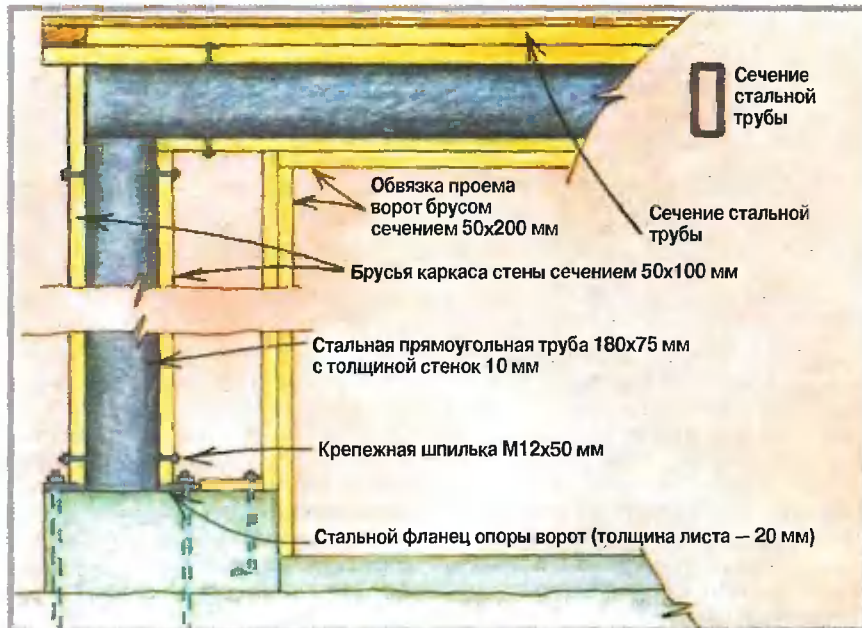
Конструкция устойчивой к землетрясению металлической коробки гаражных ворот
